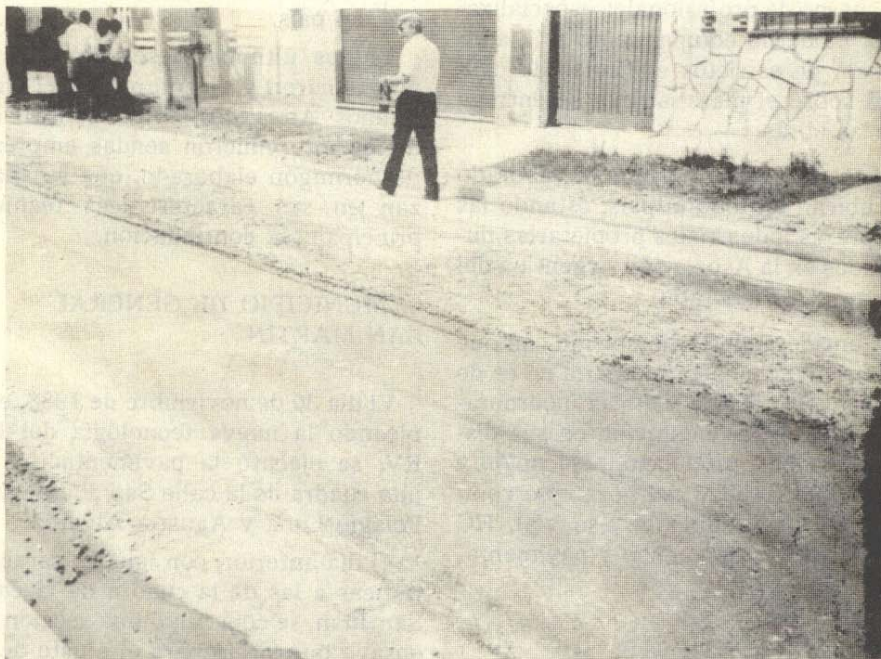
Vista general de un carril terminado; observar el detalle del cordón cuneta sobre el carril no ejecutado. San Martín.
